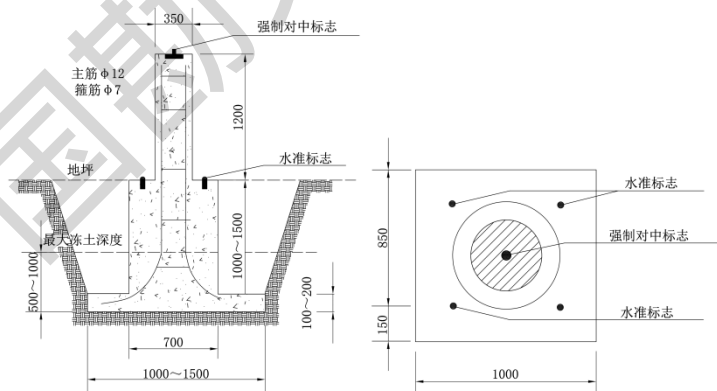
土层水平位移观测墩剖面图与俯视图（单位：mm）
